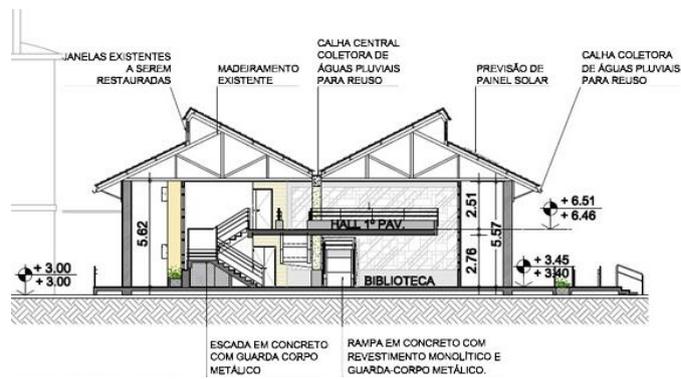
Planta técnicas – Biblioteca Parque de Manguinhos, Rio de Janeiro
